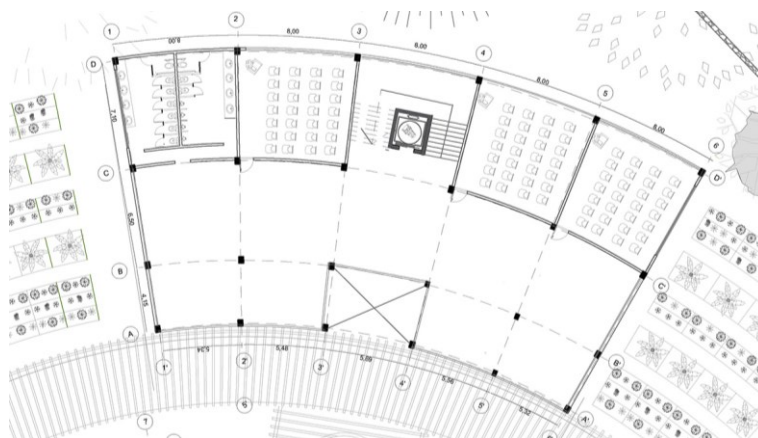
Planta 2do y 3er piso bloque Técnico y Tecnológico. Fuente: Elaboración propia.
